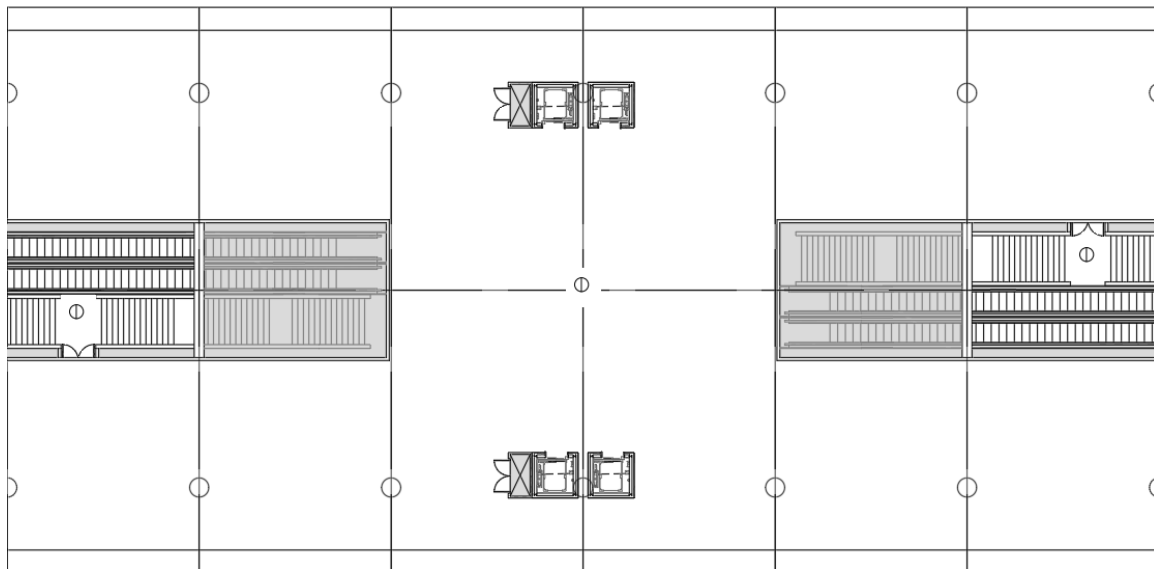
Sistema Megafonía ascensores Planta 1 Estación típica
